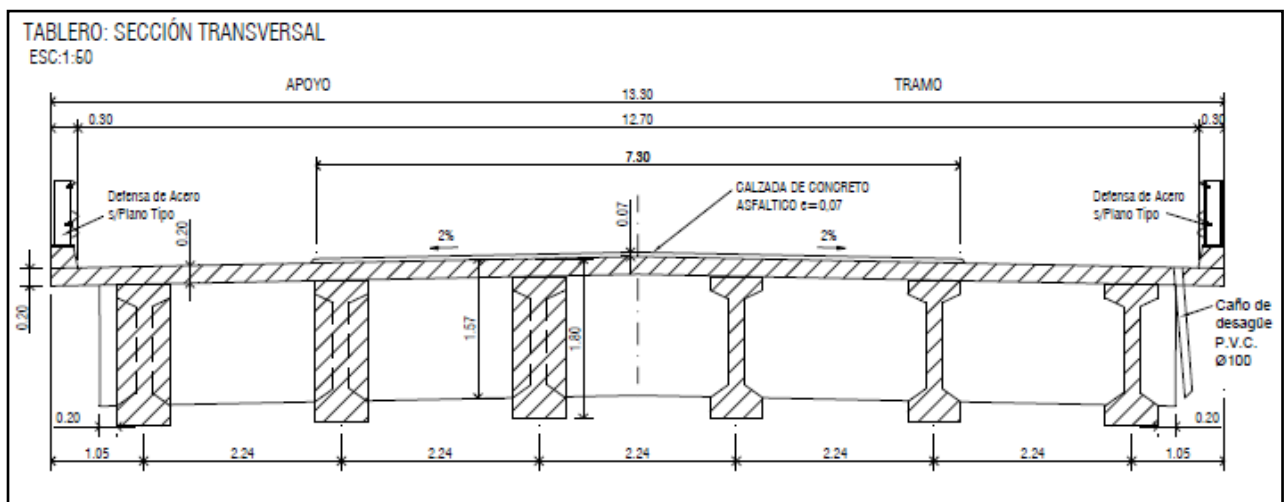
Transversal PUENTE SOBRE RÍO CTALAMOCHITA.
